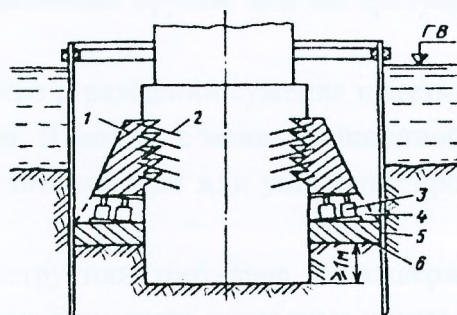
Усиление фундамента уширением: 1 – железобетонные консоли; 2 – анкер; 3 – дамкрат; 4 – участок, бетонируемый после обжатия грунта; 5 – шпунтовое ограждение; 6 – бетонная плита.
